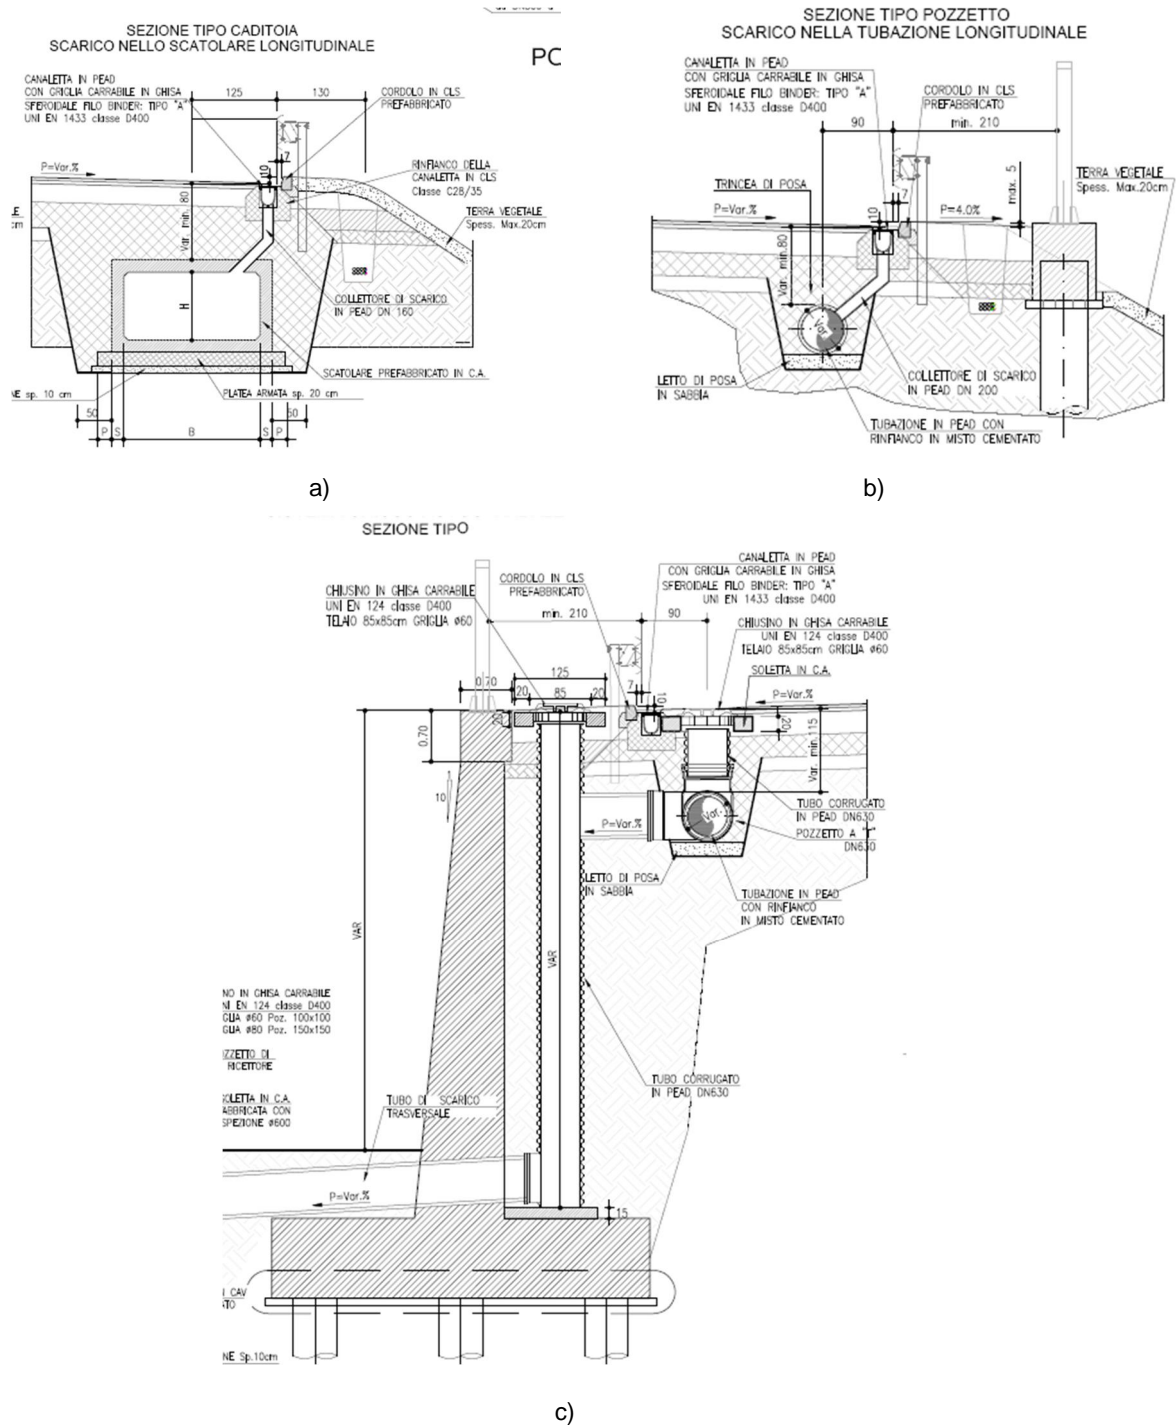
Sezioni tipo opere smaltimento acque di piattaforma su muro di sostegno: su scatolare in calcestruzzo armato a); con barriera FOA b); con sola barriera bordo ponte c).
